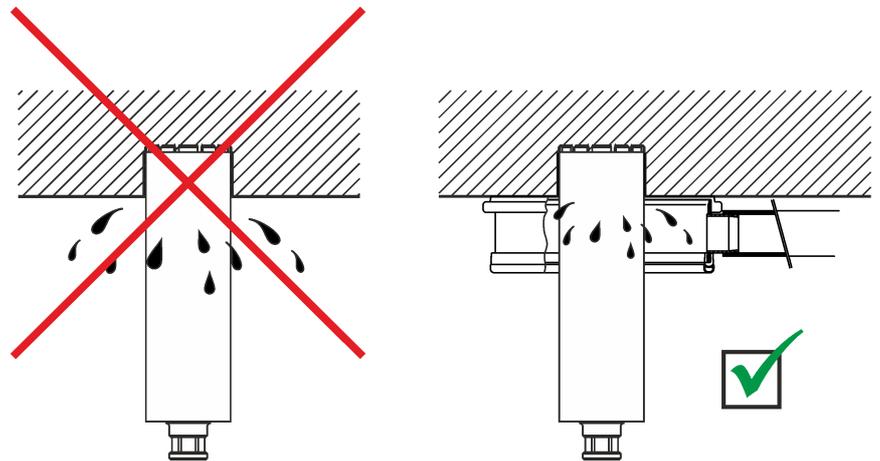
Wassersammelring / Überkopfb Bohrungen
